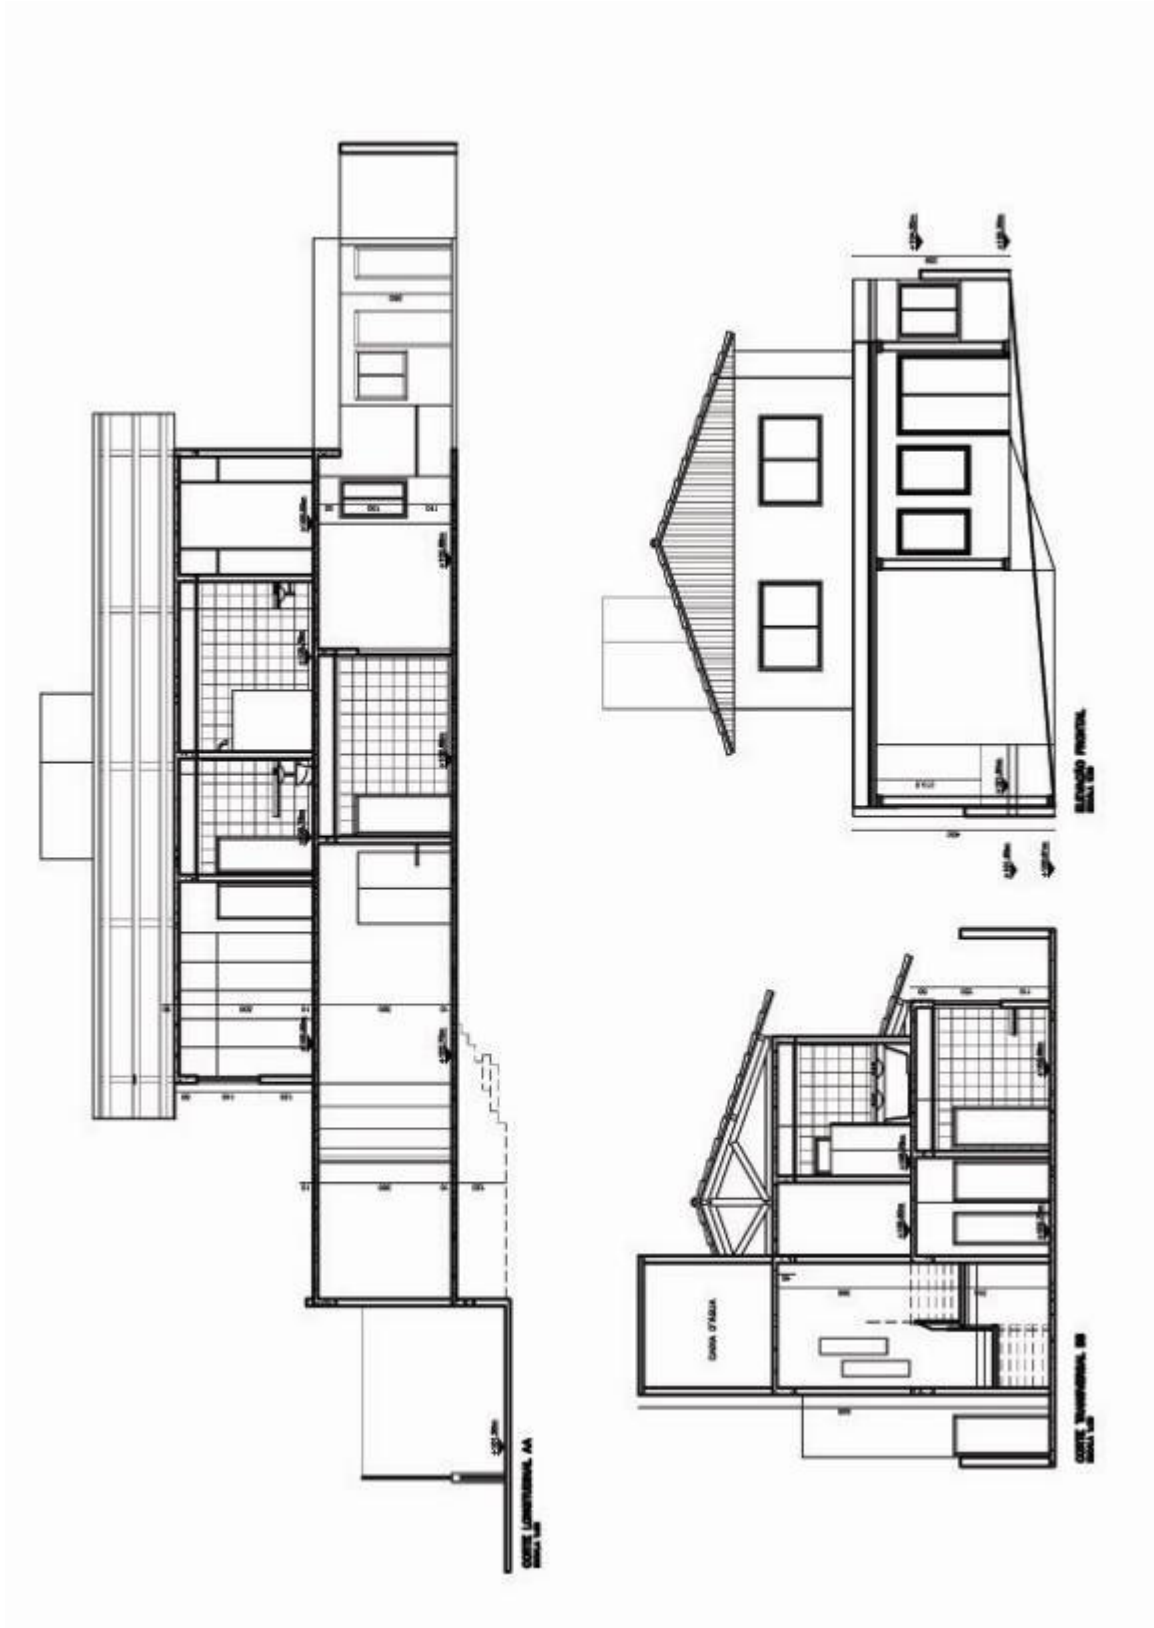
Exemplo de corte e elevação de projeto arquitetônico
